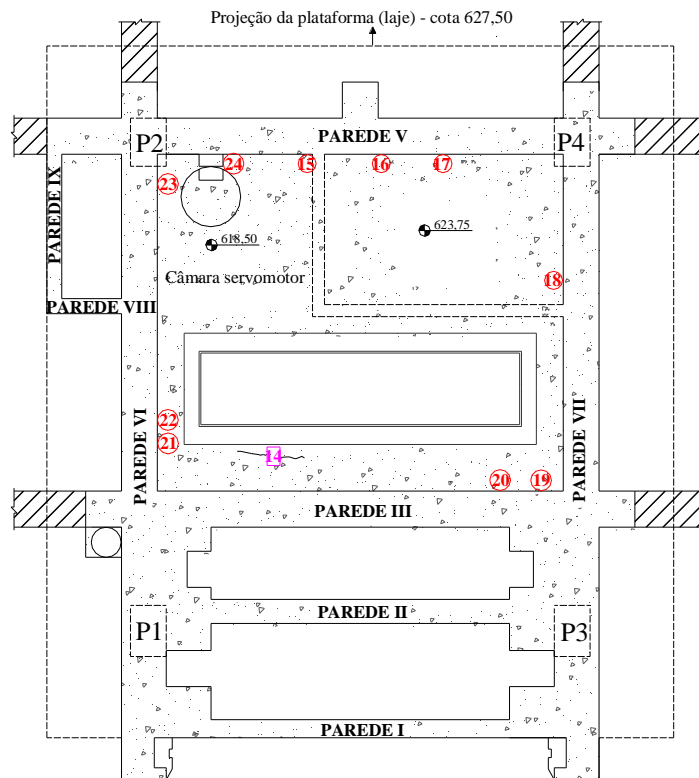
Localização de MT e BT nas paredes internas da câmara do servomotor. Vista em planta
